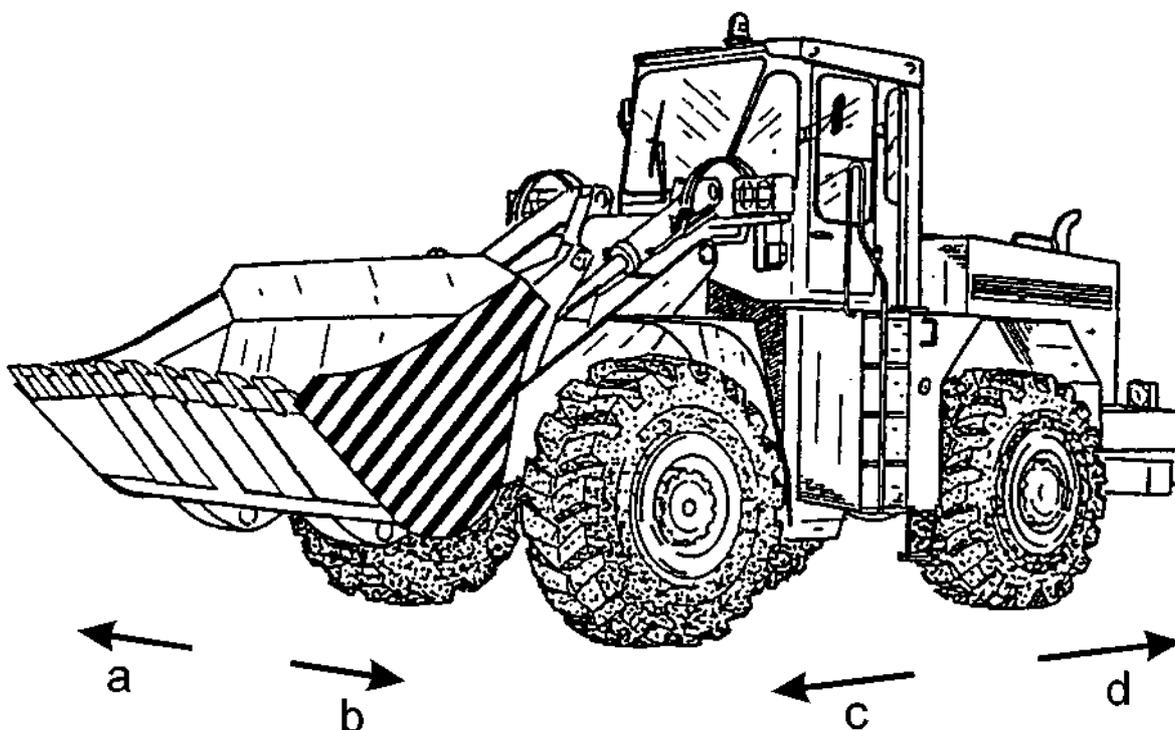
Погрузчик фронтальный колесный L-34В (вид слева спереди)
